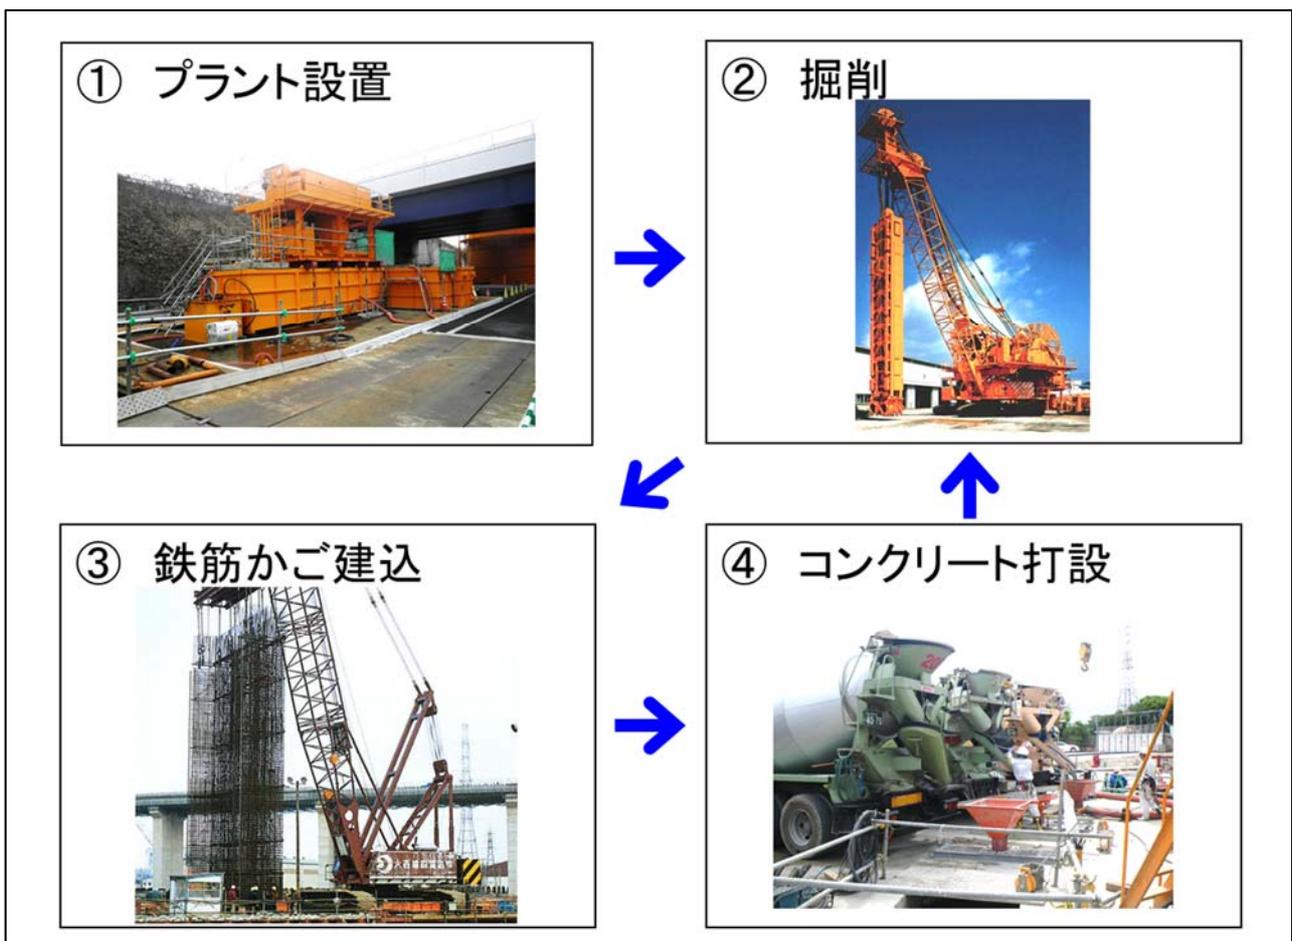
(5) 地中連続壁工の施工手順（写真は類似工事の例）
